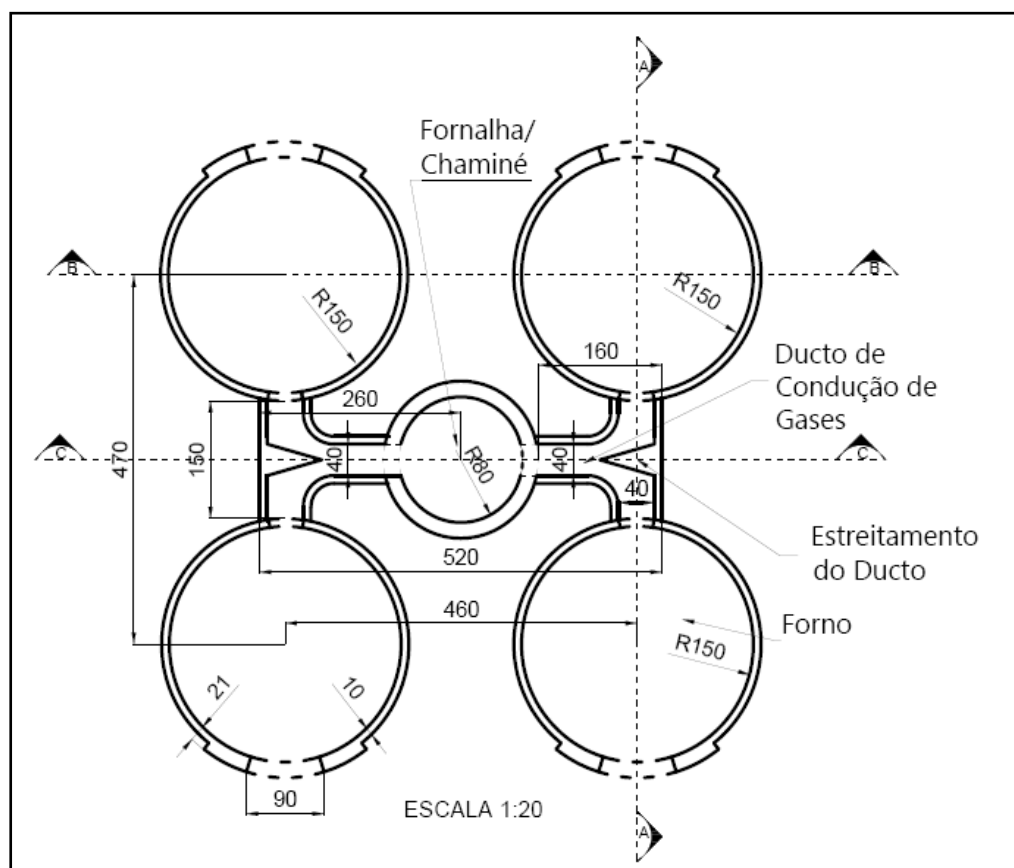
Planta baixa do sistema forno-fornalha, com medidas em centímetros.
